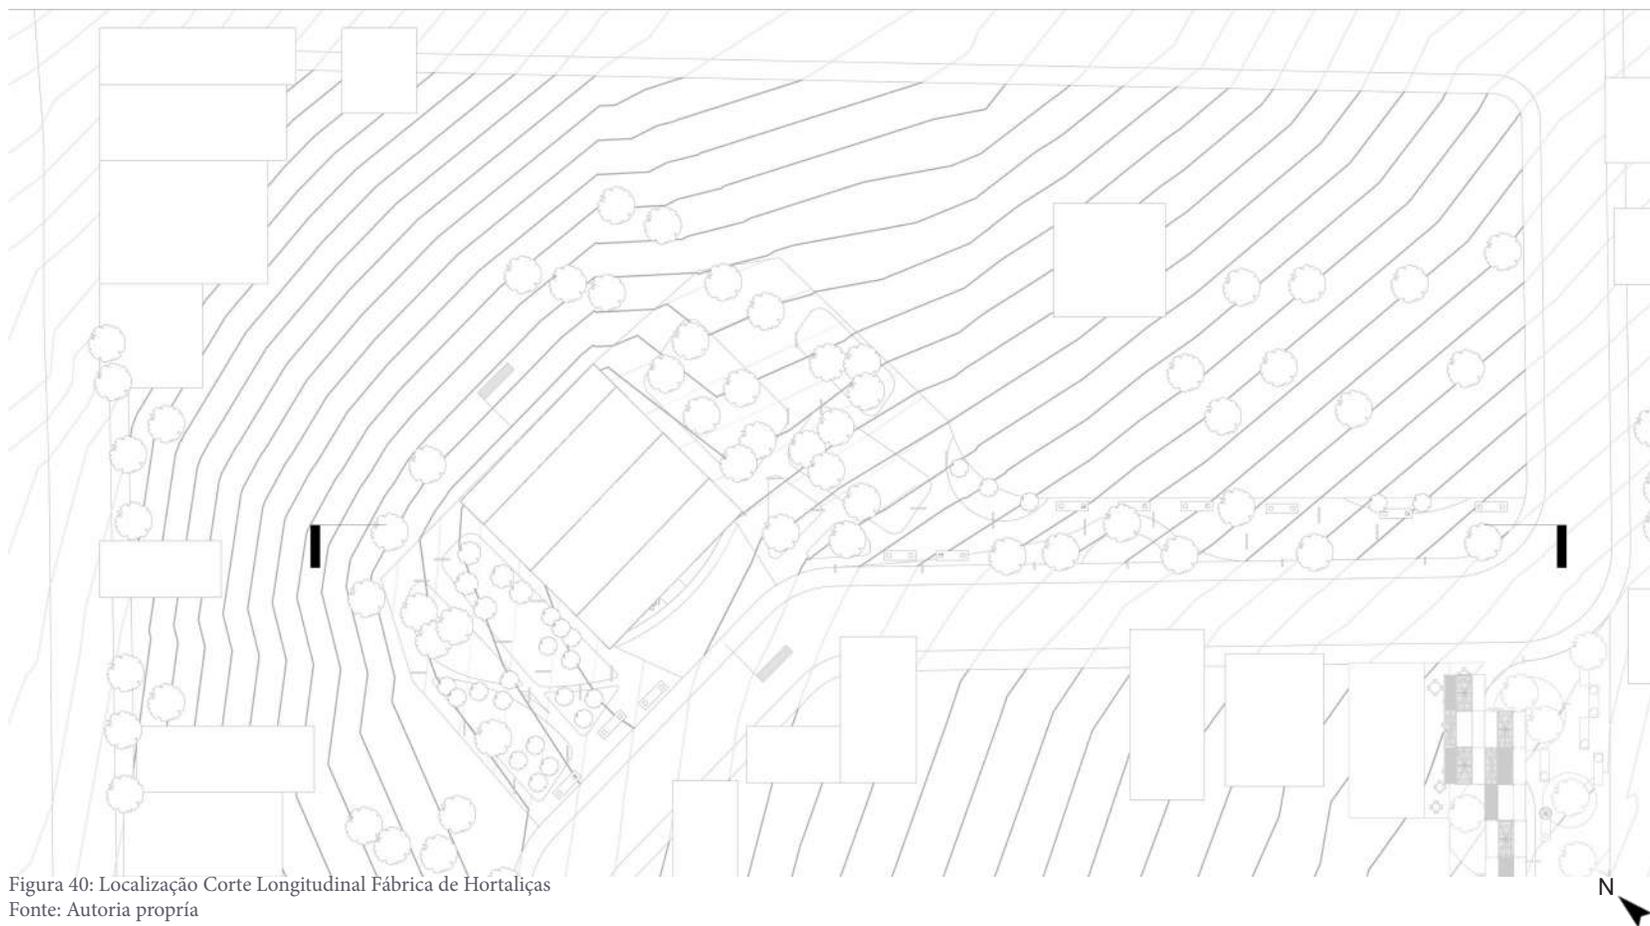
Localização Corte Longitudinal Fábrica de Hortaliças
